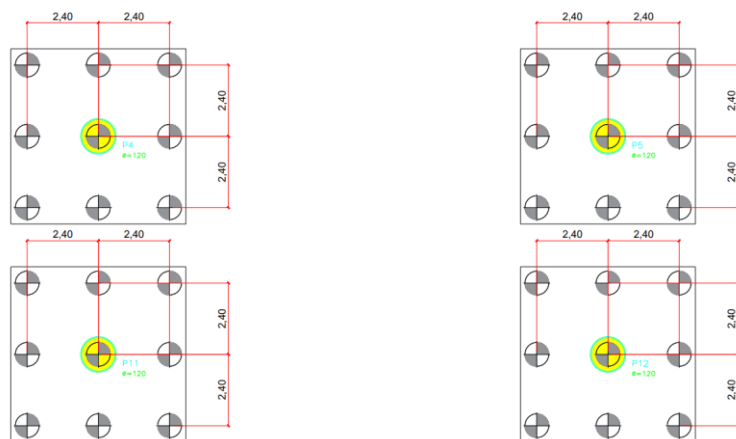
Planta baixa da fundação. Adaptado pelos autores (2026)
